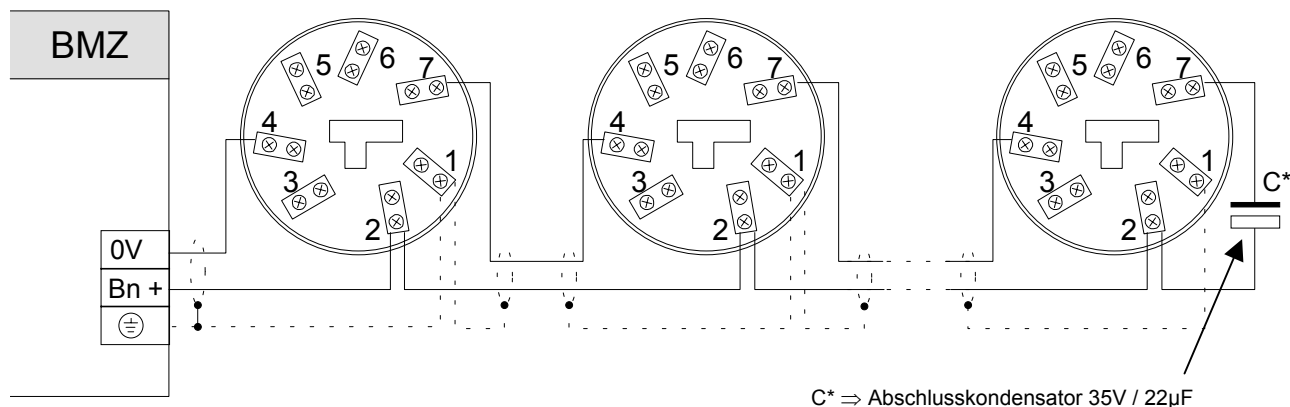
Anschaltbeispiel mit Standard-Meldersockel 781490 / 781590
